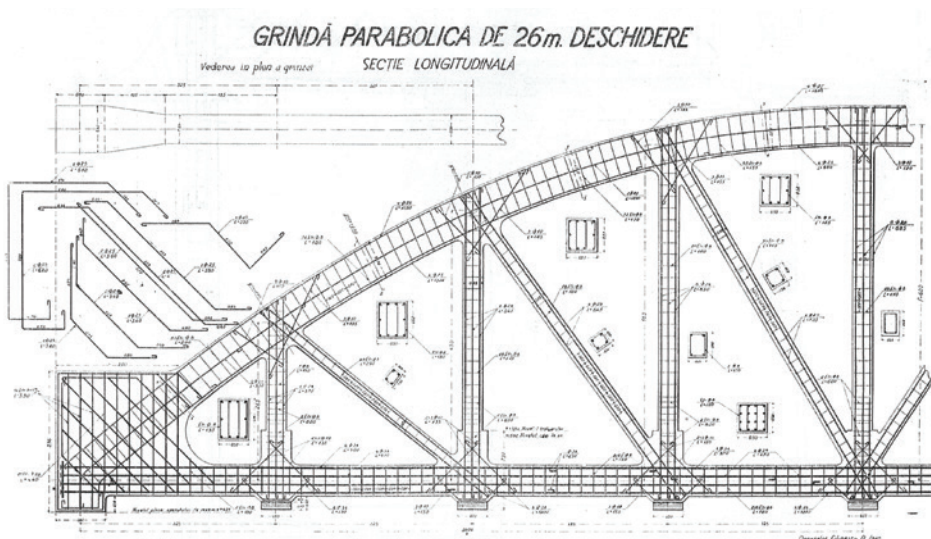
Elevația grinzii parabolice de 6 m. Secție longitudinală.
